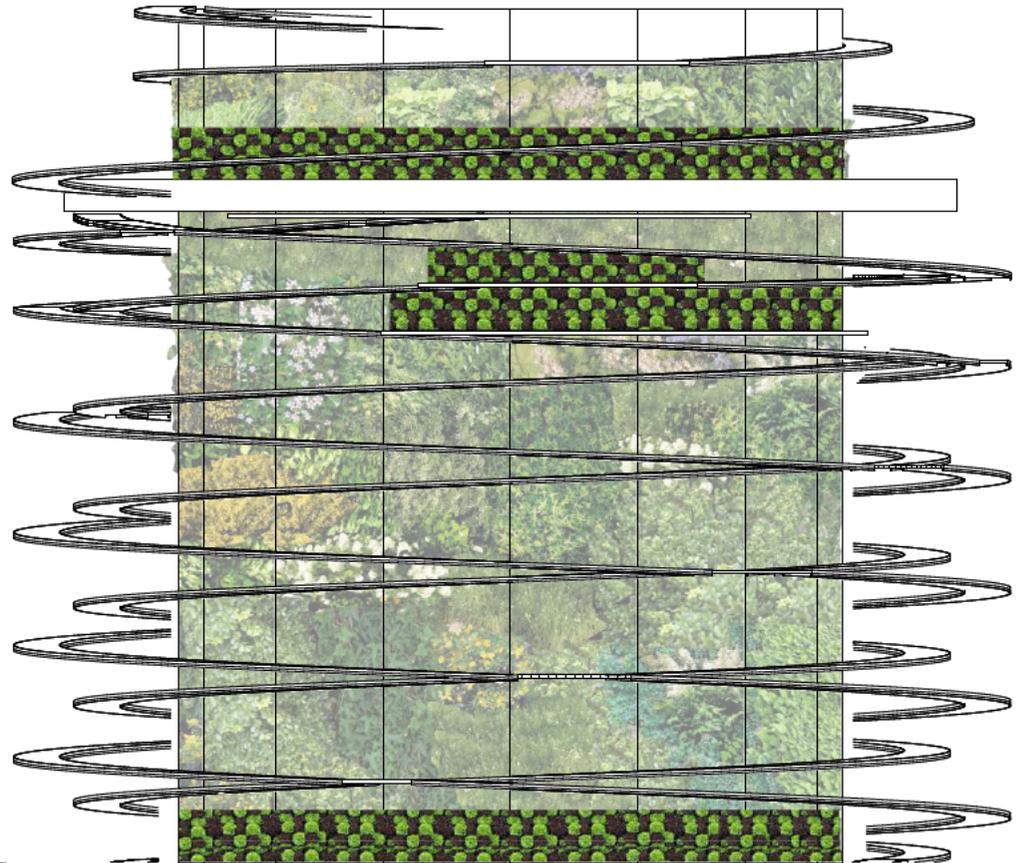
Süd Fassade, Fassadenbegrünung
